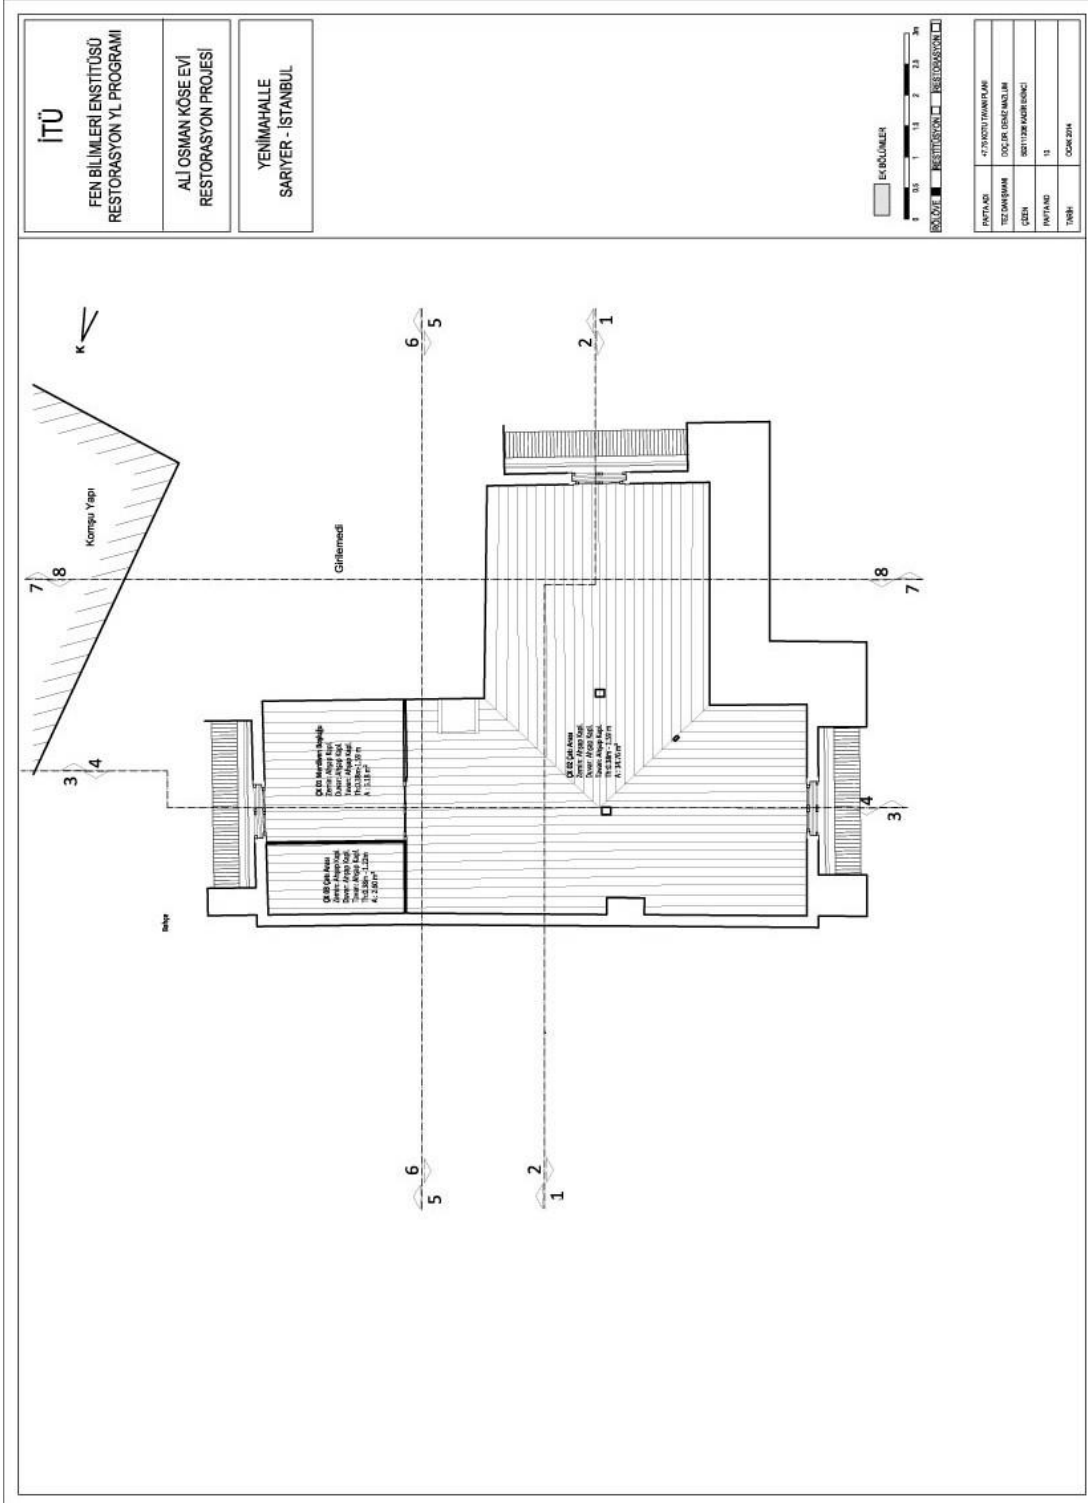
Rölöve – -0.45 kotu tavan planı.
